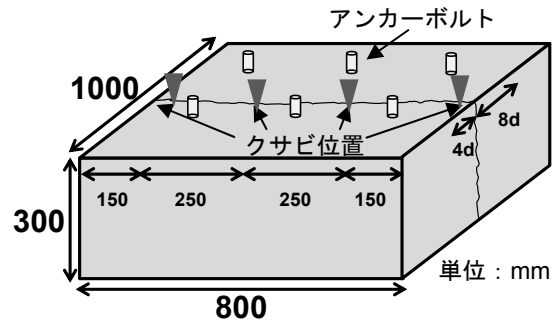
供試体概要(初期・導入ひび割れシリーズ)
